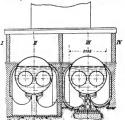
Grundriss der Livet'schen Kesseleinmauerung.
